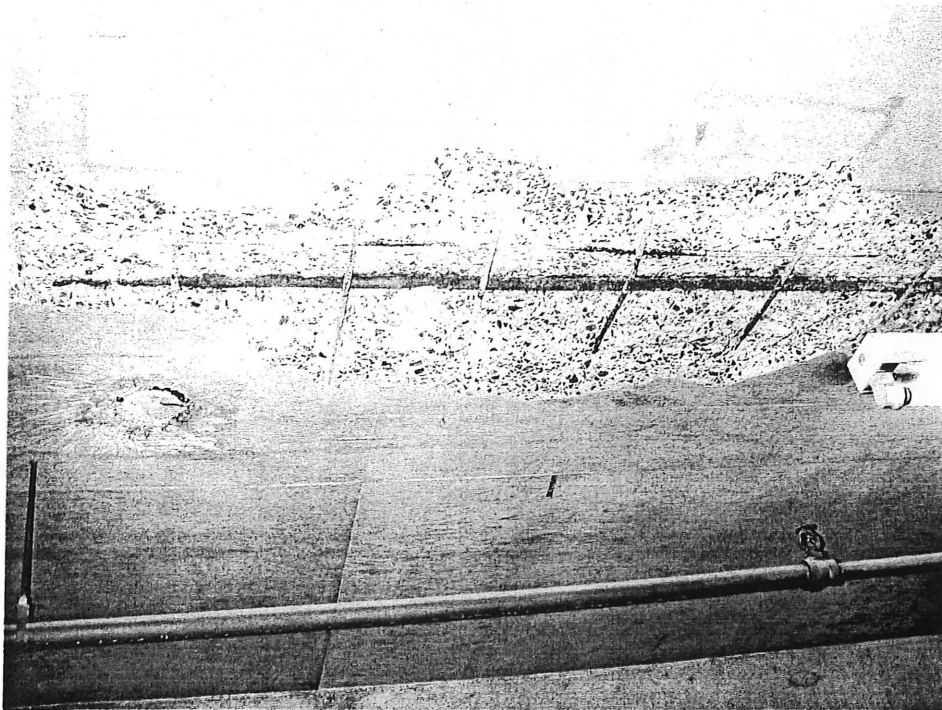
Effet de la corrosion des armatures d'acier des dalles (nappe inférieure)
